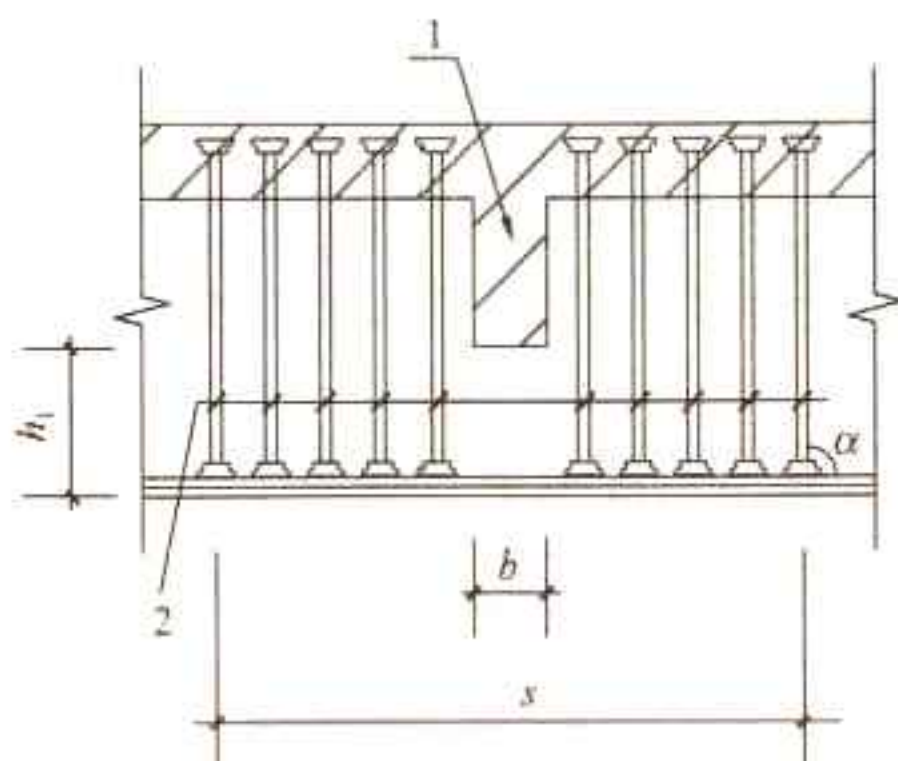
梁高度范围内有集中荷载作用时附加横向钢筋的布置
